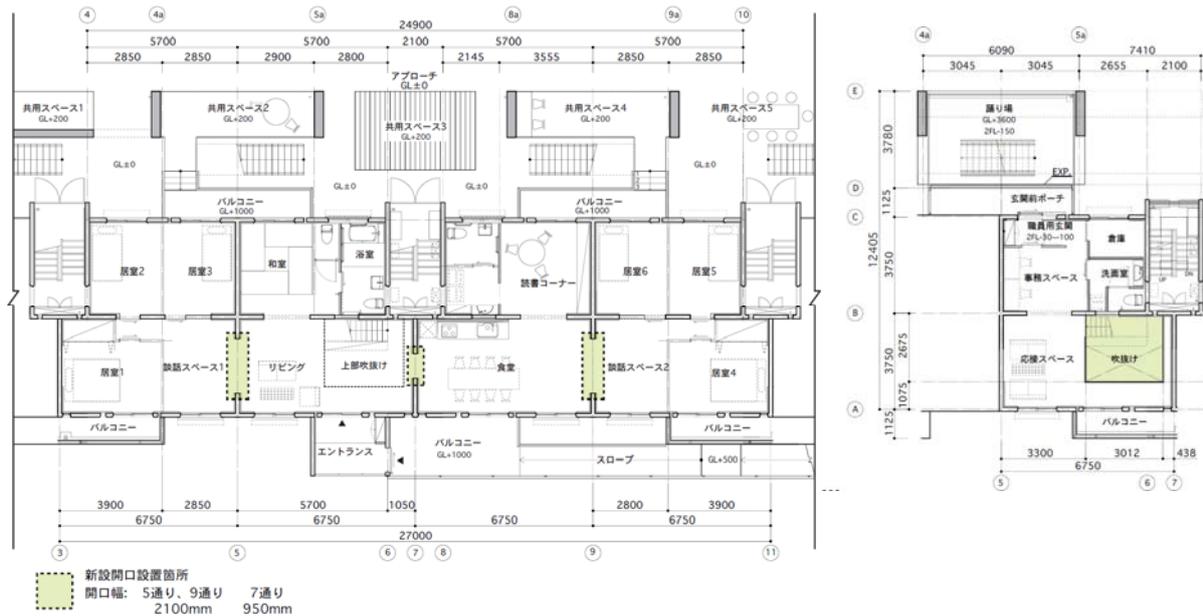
高齢者福祉施設部分の平面図（左：1 階平面図，右：2 階平面図）
